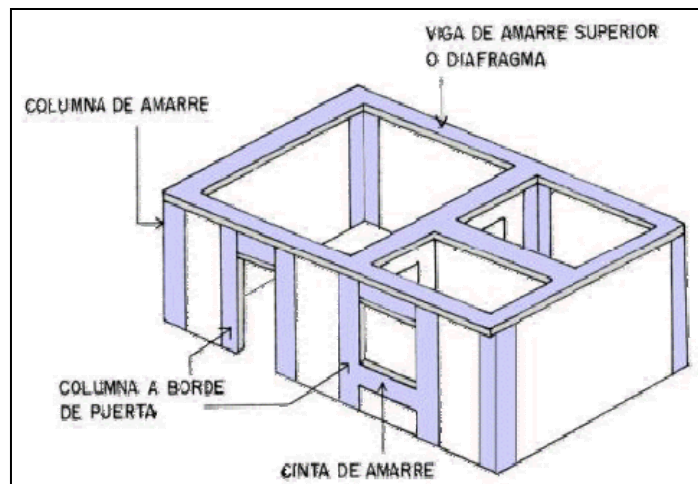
Refuerzo de la edificación: colocación de una viga collar y columnas de concreto reforzado
